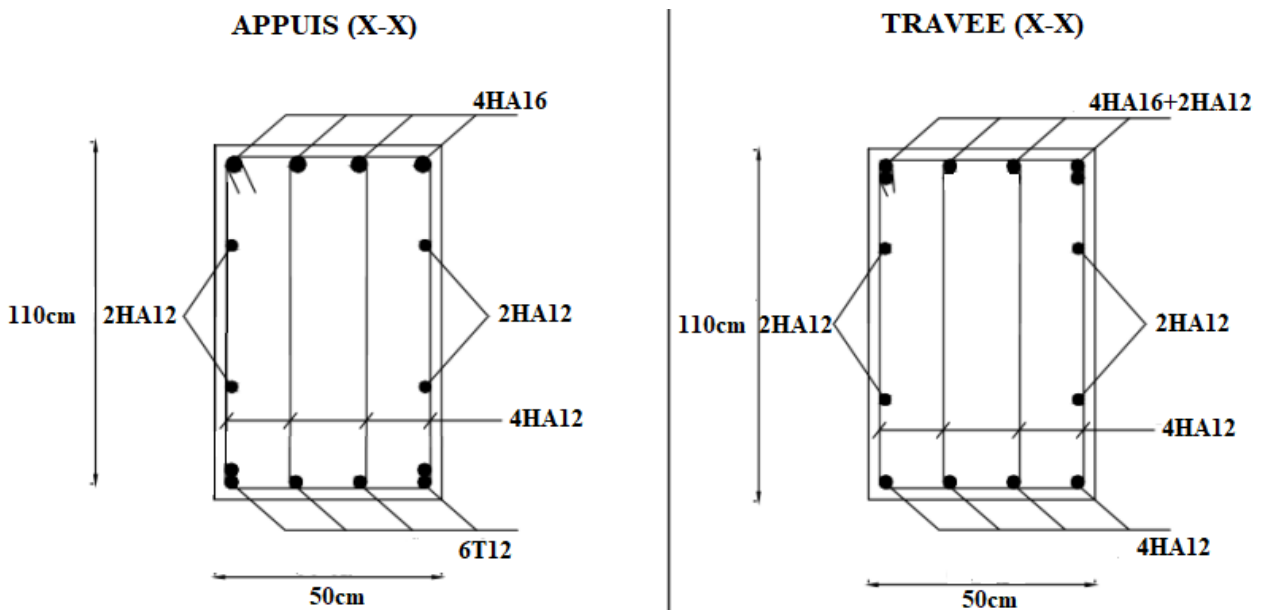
Ferrailage des nervures du sens non porteur (x-x).
